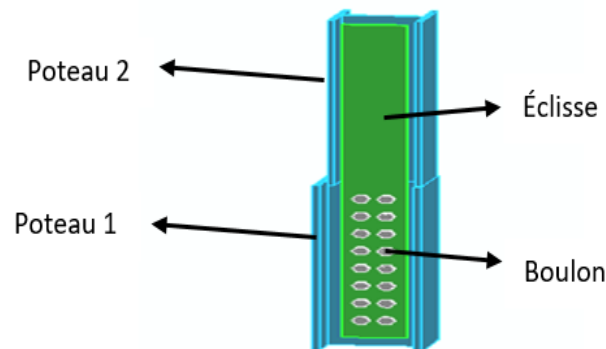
Assemblage poteau (HEB260)/poteau (HEB300).
